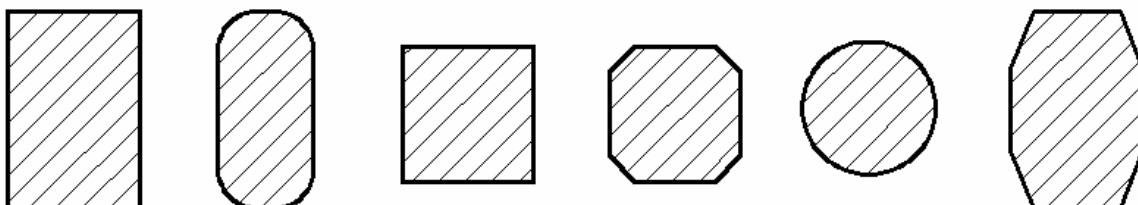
Forme în plan ale secțiunii transversale pentru pile coloane
